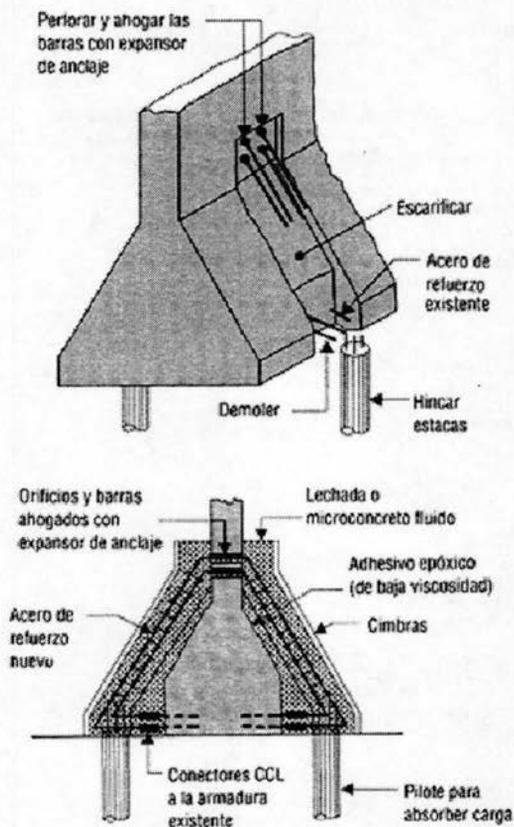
Refuerzos - Zapatas con: a) lechada de base cemento / microconcreto fluido y b) concreto
